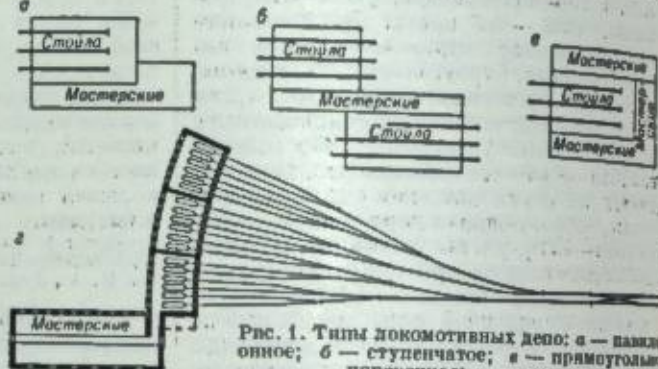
Типы локомотивных депо: а — параллельное; б — ступенчатое; в — прямоугольно-поперечное; г — веерное.
